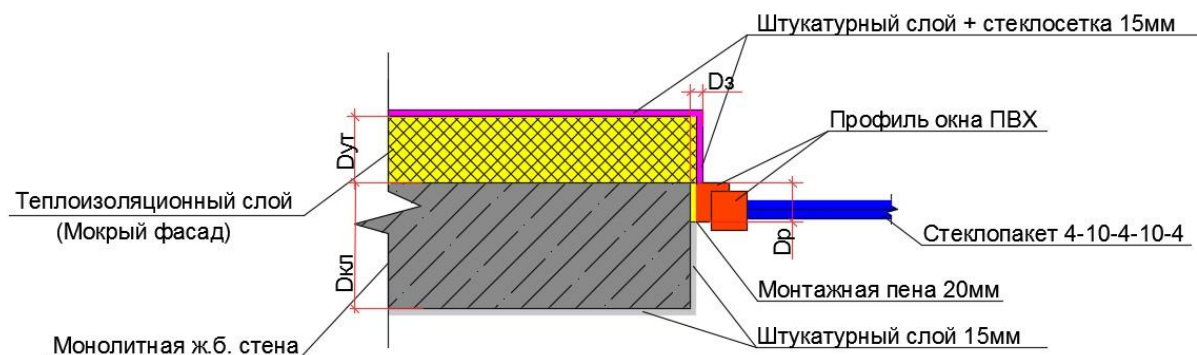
Расчетная схема для ELCUT 6.0 (Монолитная стена, мокрый фасад)
